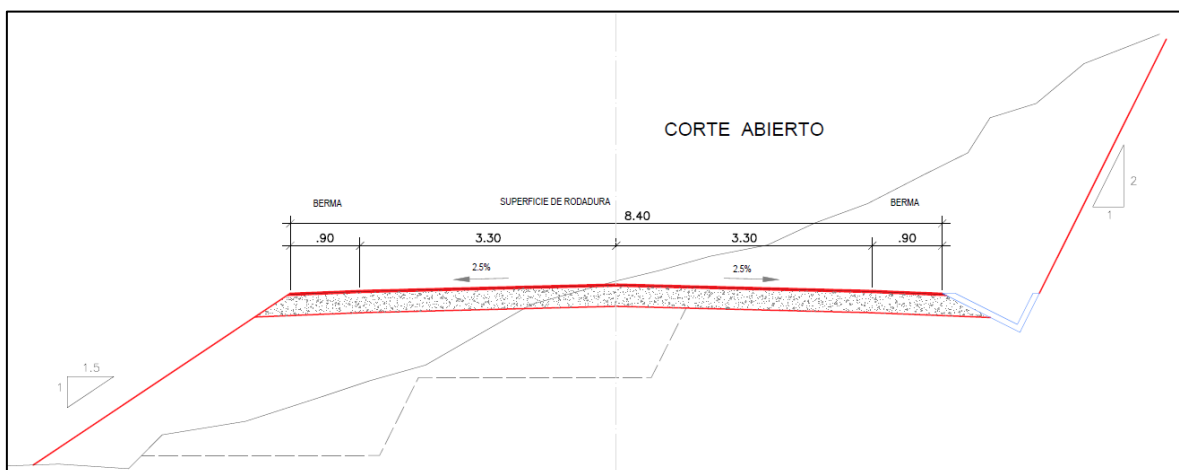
Sección Tipo I Tramo Dv. Pallar – Cochabamba
